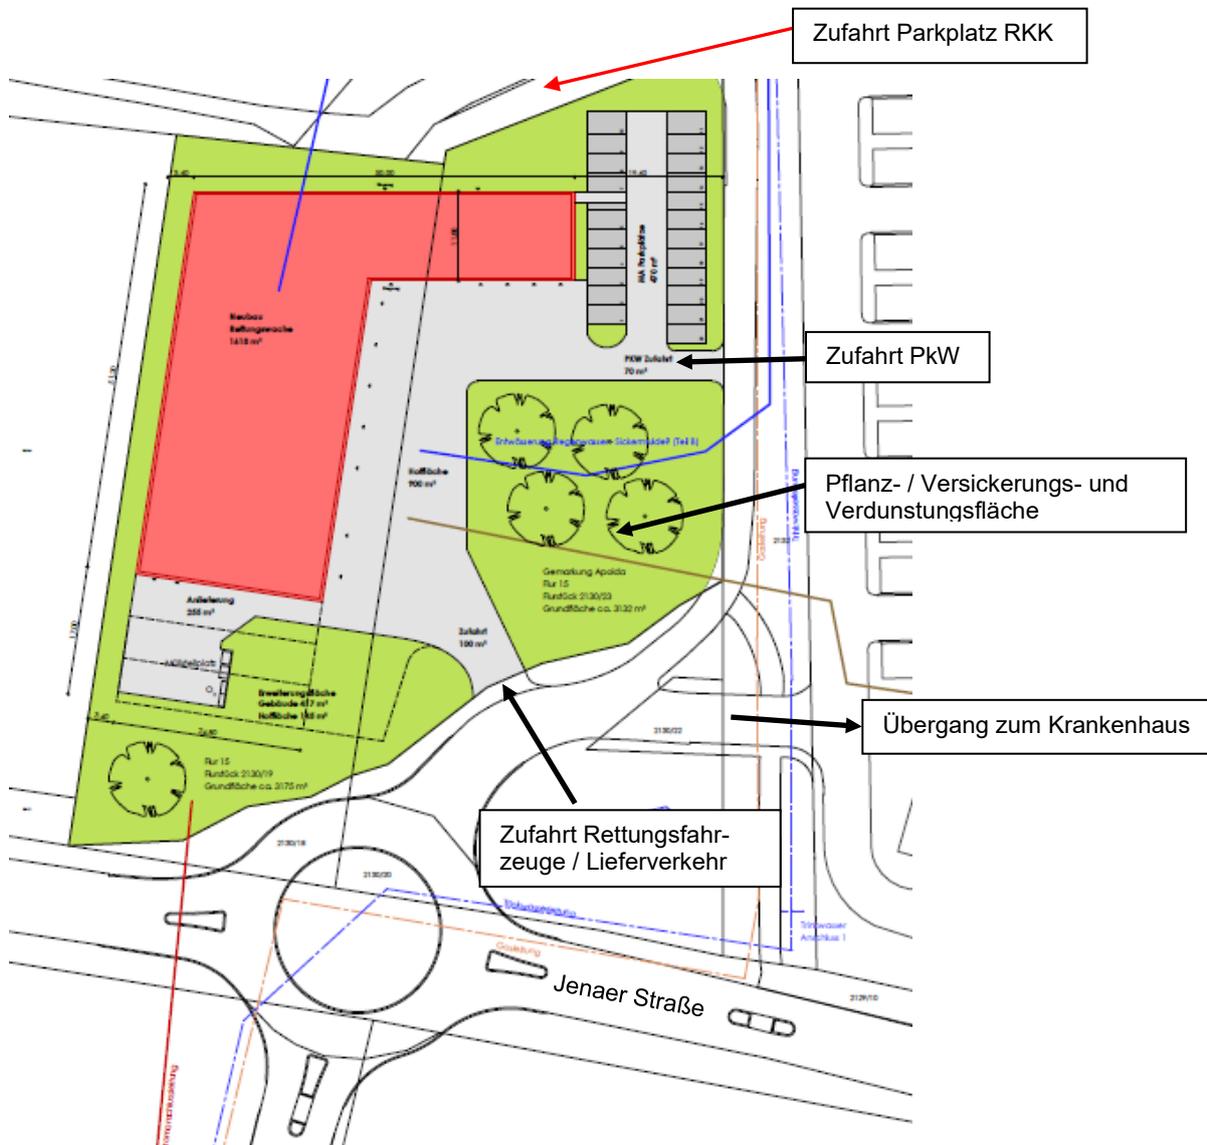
Freiraumkonzept Lageplan (pgf – Stand: 03.2022) - unmaßstäblich
